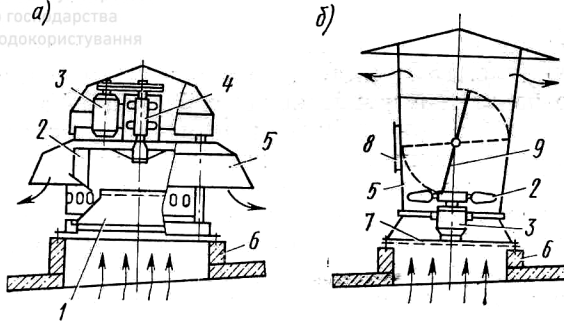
Осьовий вентилятор: 1- корпус; 2-лопаті робочого колеса; 3- електродвигун
